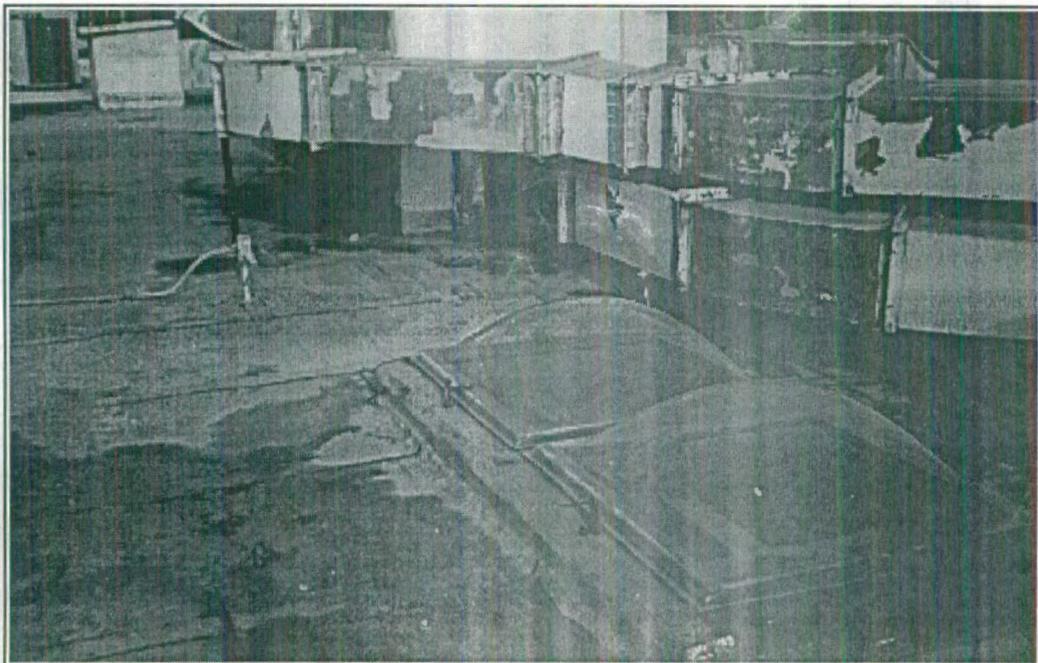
Vista del estado de la impermeabilización de la cubierta.
